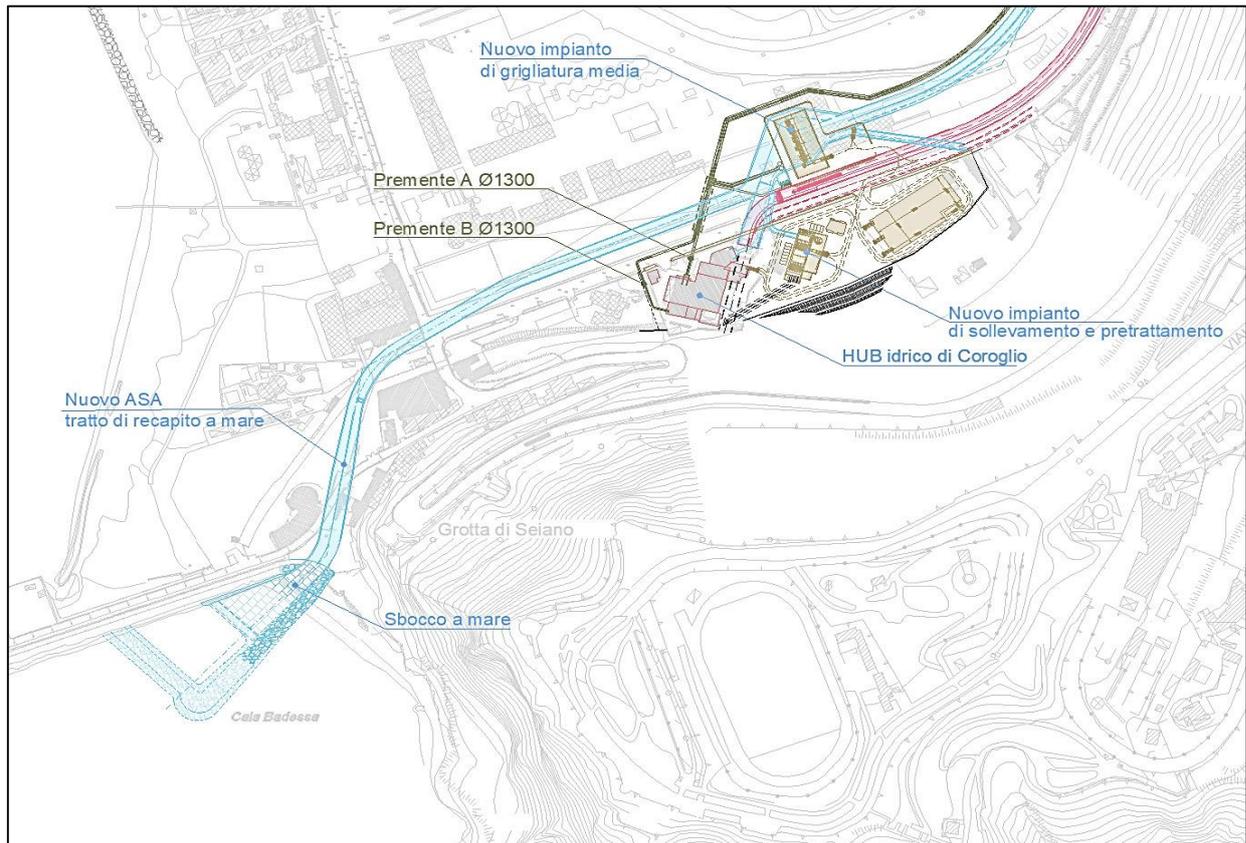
Planimetrie tratte dal progetto in oggetto.
